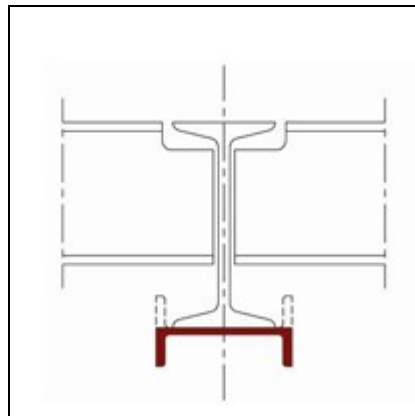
c Ajout d'un profil sous la semelle inférieure
